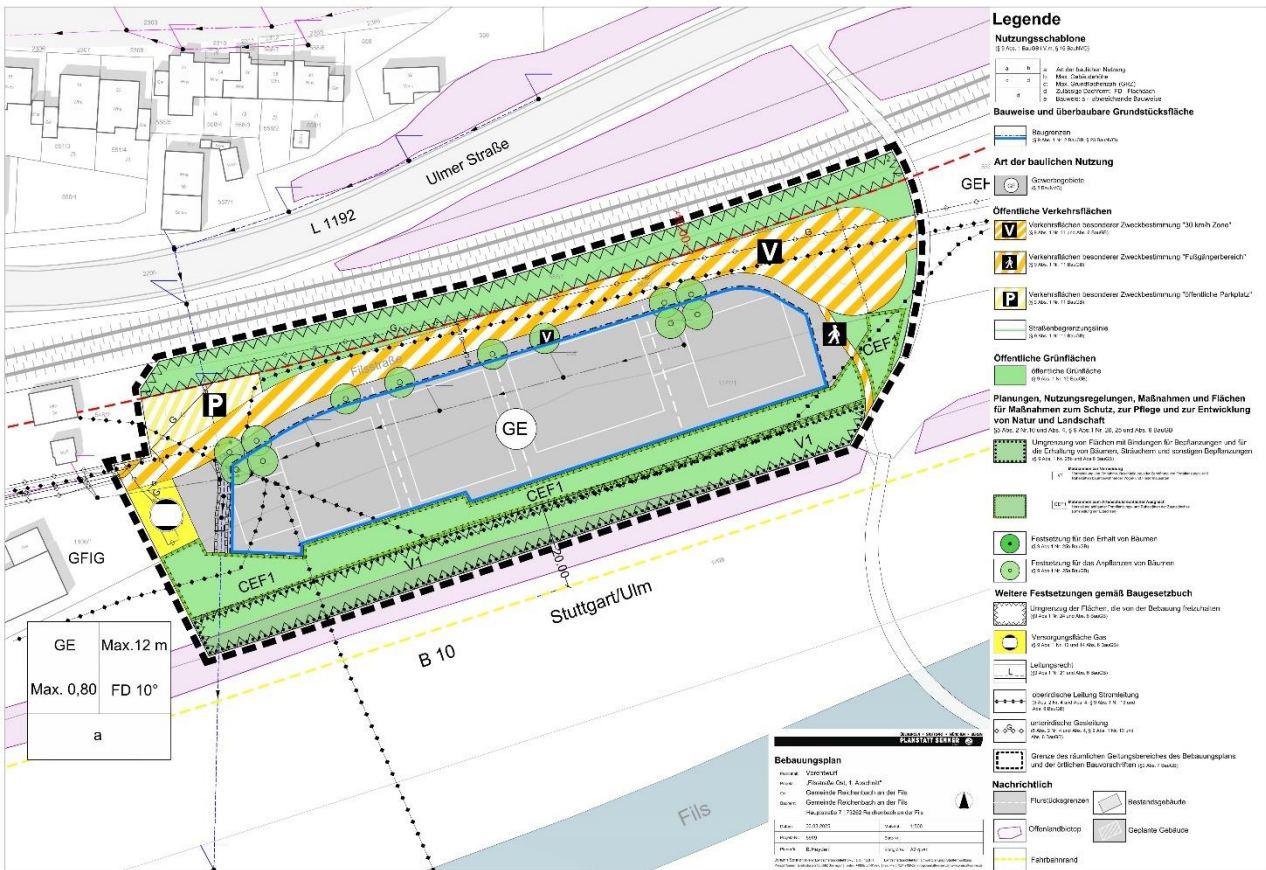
Bebauungsplan Filstraße Ost (Stand 03.03.2025 Planstatt Senner)
